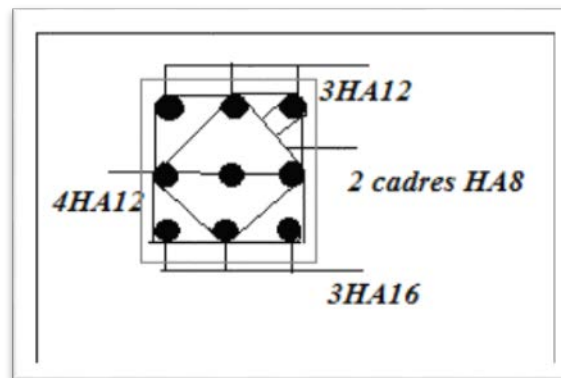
Schéma de ferrailage de poutre palière type 02 et 04
